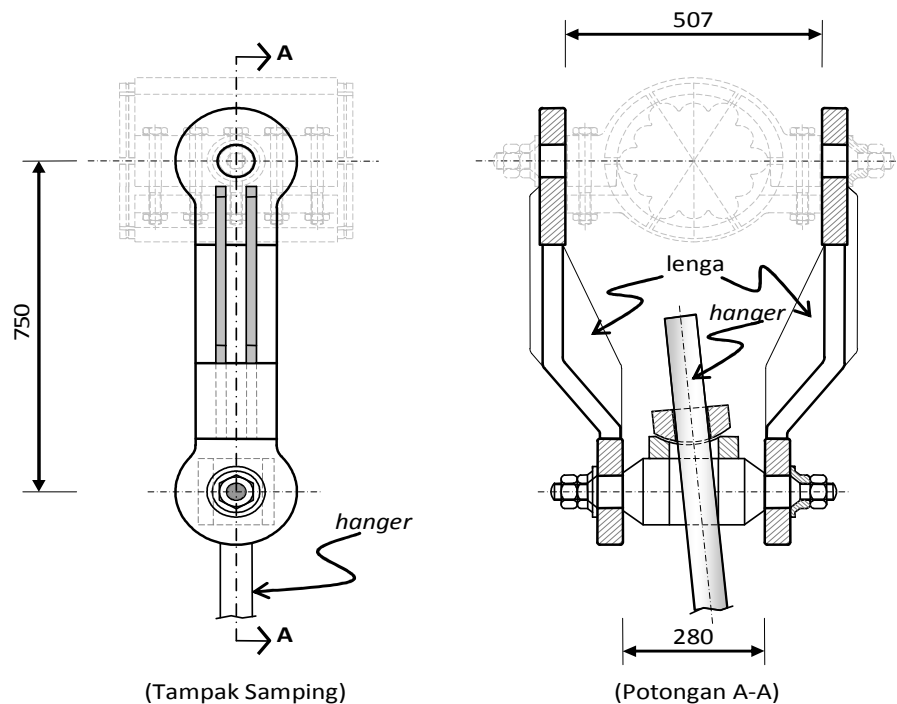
Tower strap sebagai pengikat rangka jembatan langsung pada pilon baja
